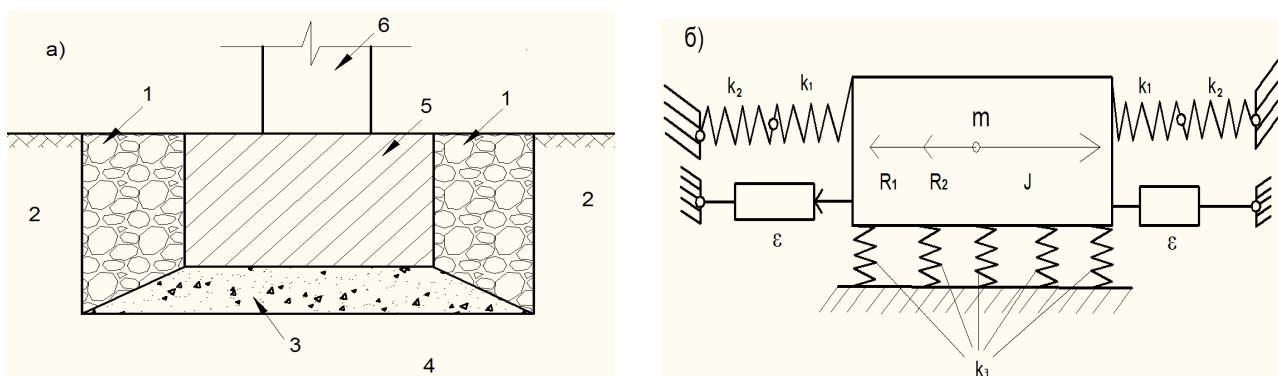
Конструкция фундамента и основания и расчетная схема
